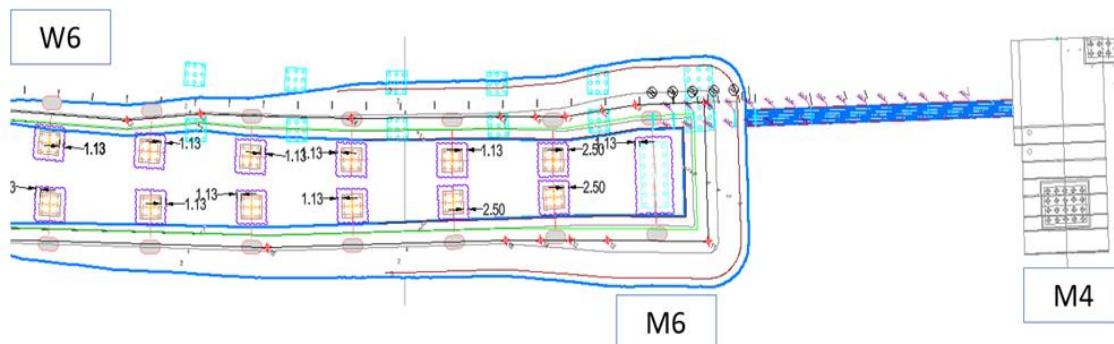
Vista de planta del relleno propuesto desde la pila W6 hasta M6, y del puente metálico desde M6 hasta M4.
